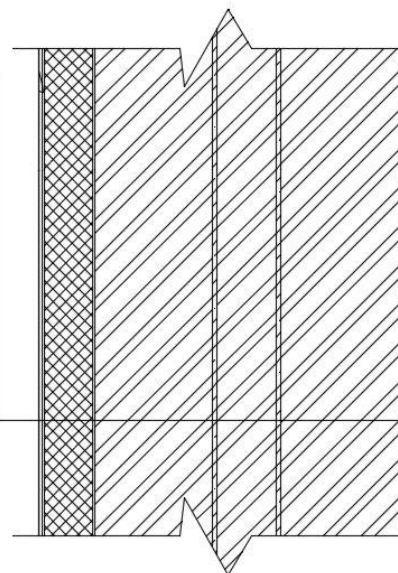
Состав наружной стены 1-го, 2-го этажей
